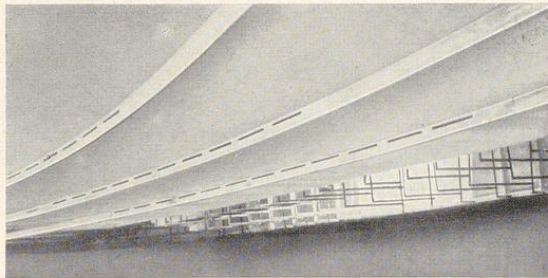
In die Decke eingebaute Entlüftungsschlitze aus Zürich
